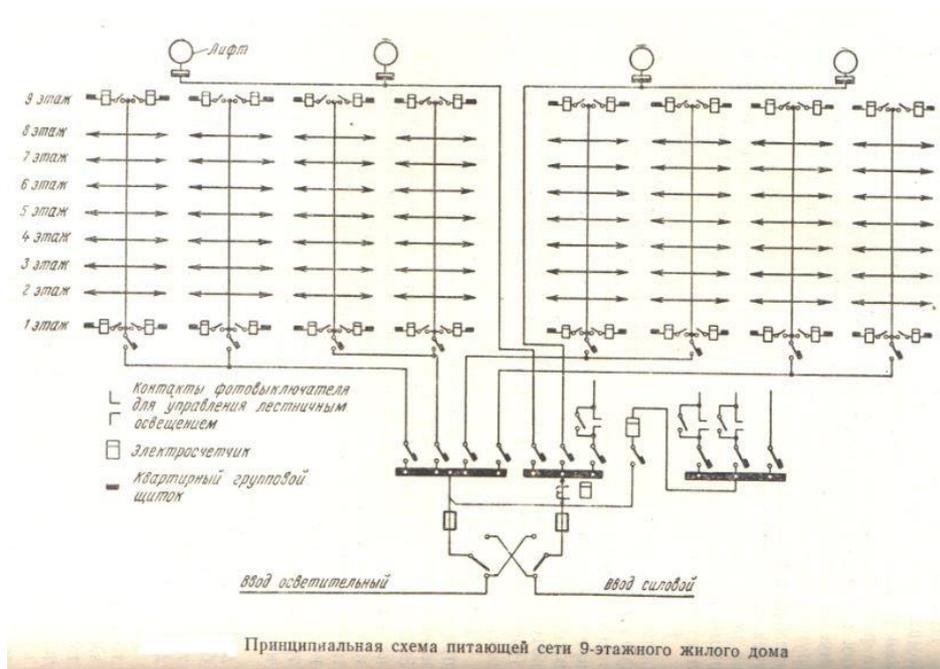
Принципиальная схема питающей сети 9-этажного жилого дома.
